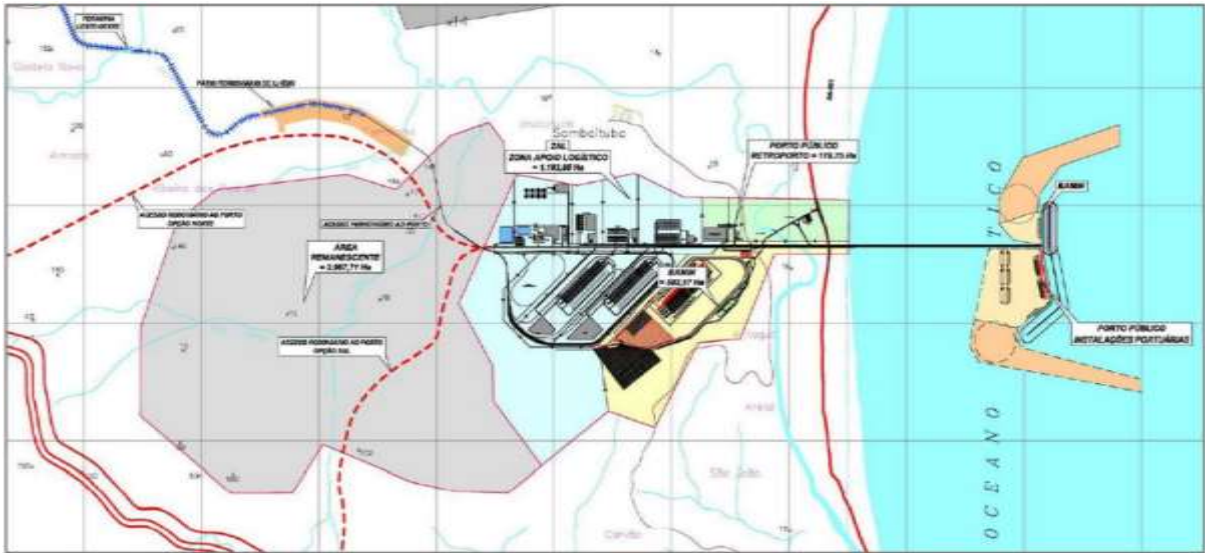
Layout do projeto Fonte: BAMIN - GOVBA
